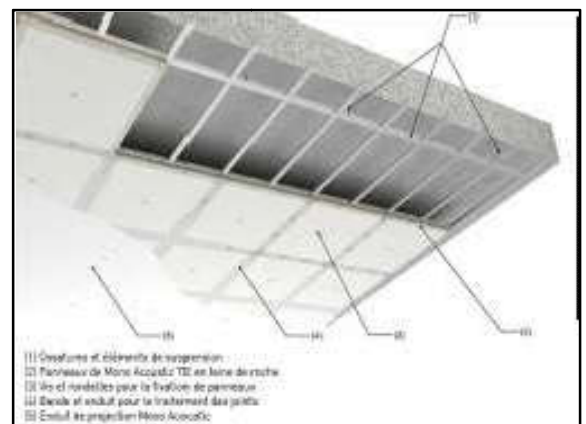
Plafond rock fon acoustique démontage en cas de défaillance technique ; elles sont donc indépendantes les unes des autres.
